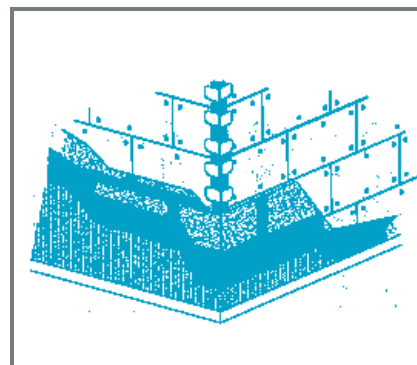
Mise en œuvre enduit 3 couches finition ribbée
